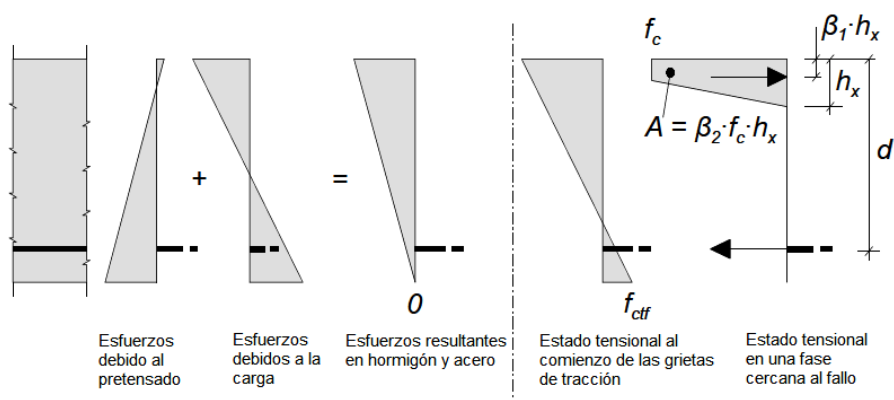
Evolución del estado tensional en la losa alveolar.
